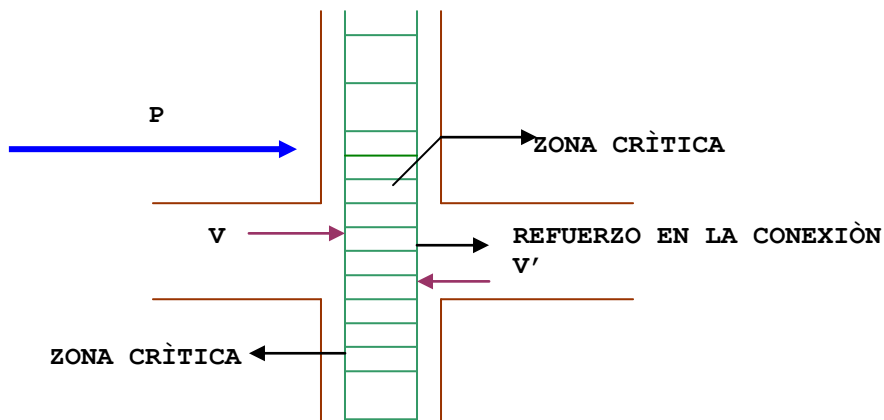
Acción de cargas sísmicas en conexiones viga - columna.
